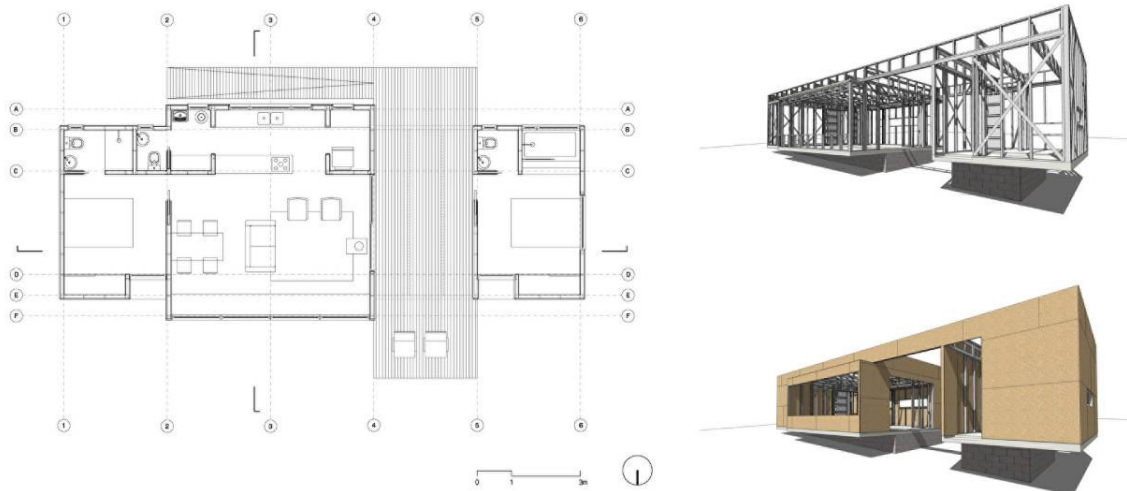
Planta y Modelo Digital Constructivo de Refugio (studioparalelo)
